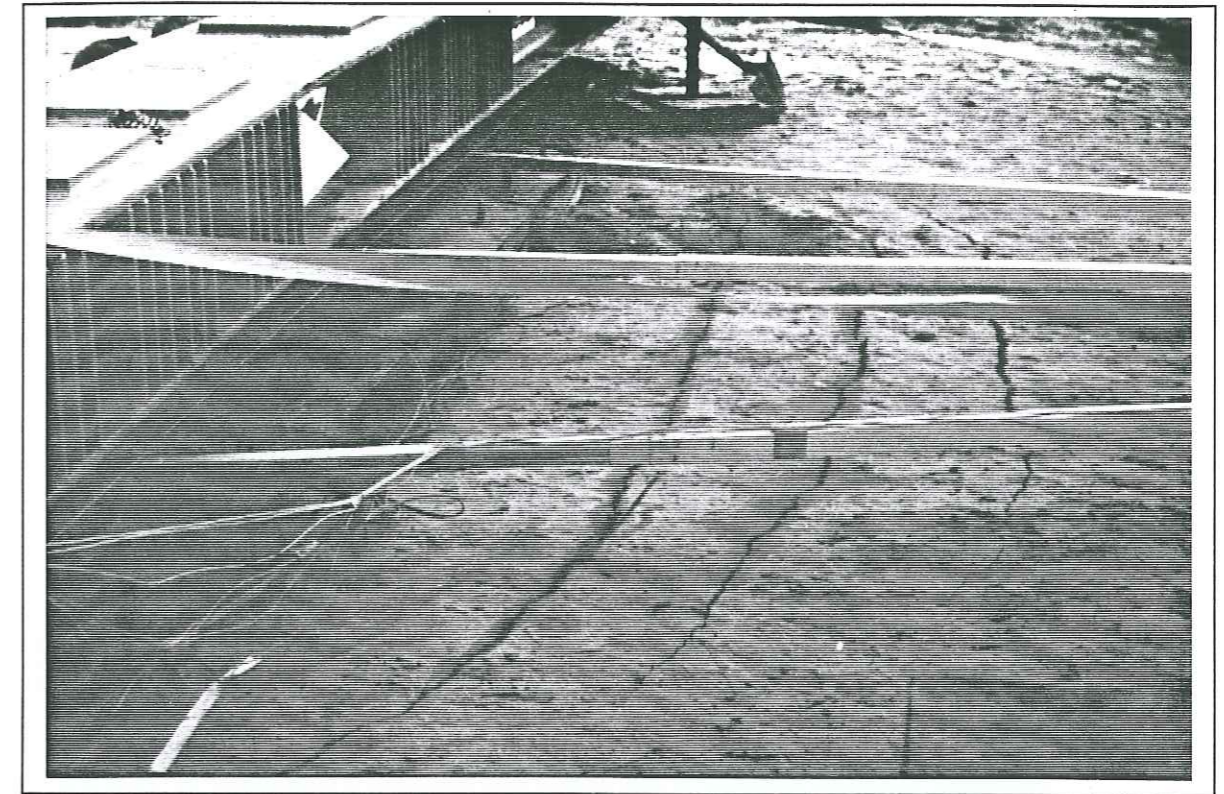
Fissuration à la surface du massif NT en fin d'essai
